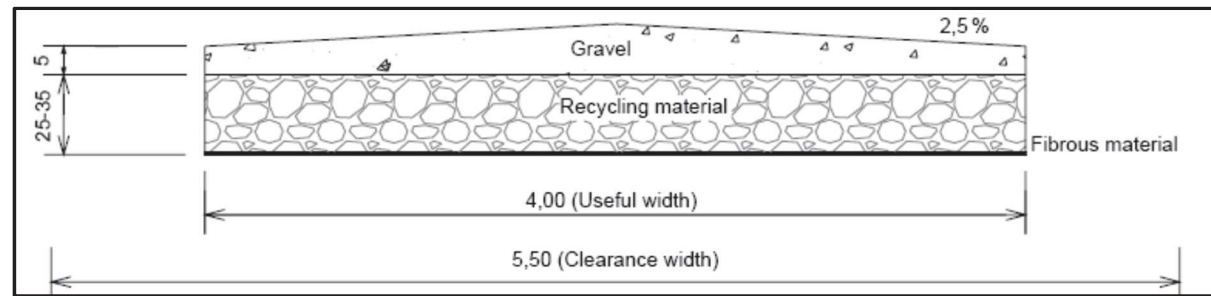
Schéma de principe : coupe de la bande de roulement d'une piste d'accès
